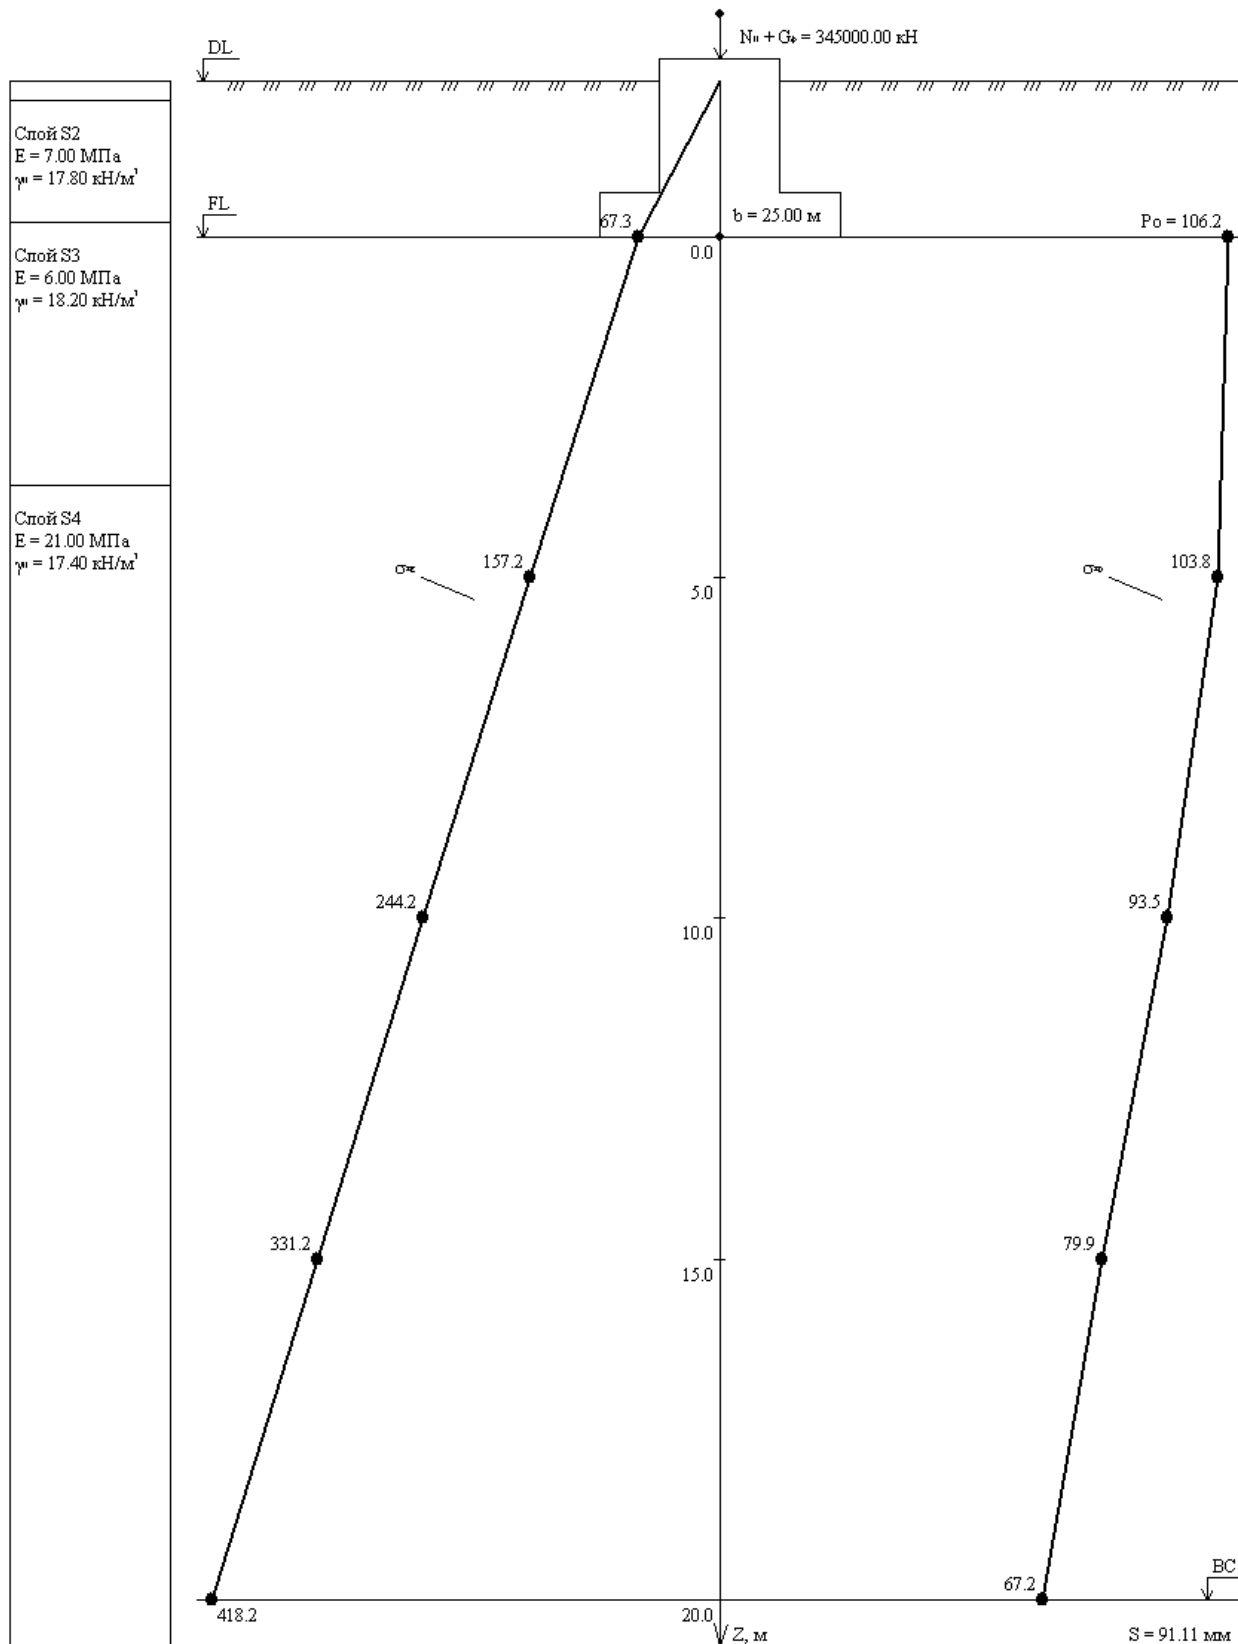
Расчетная схема вычисления осадки монолитной плиты
